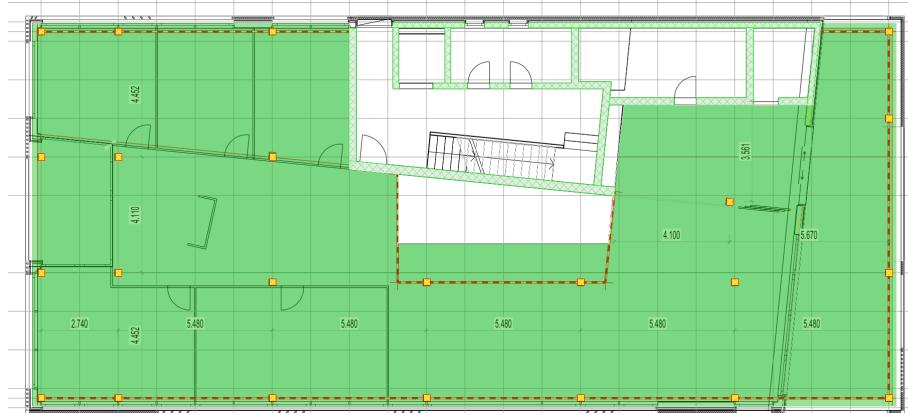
Grundriss mit Brettsperrholzdecke (grün), Stützen (gelb) und Erschliessungskern in Stahlbeton
